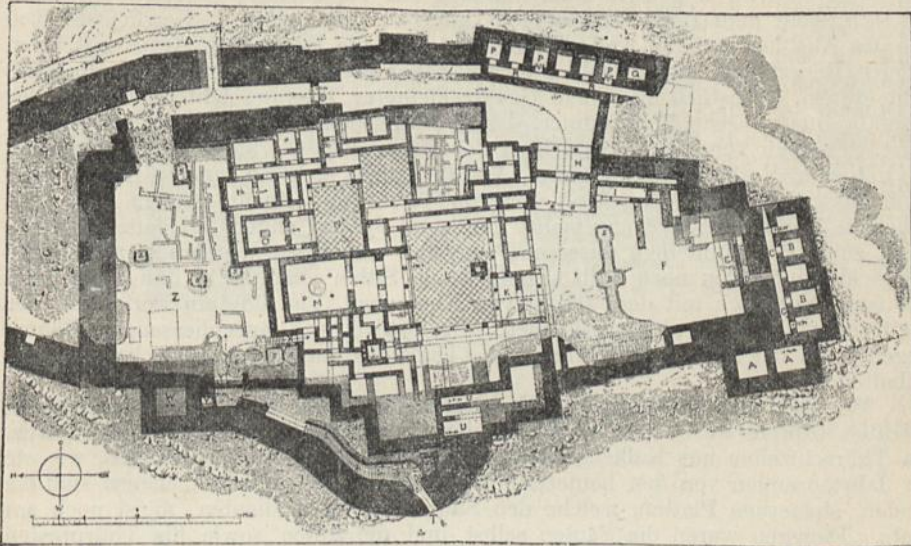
Grundriss des Palastes von Tiryns. (Schliemann.)
